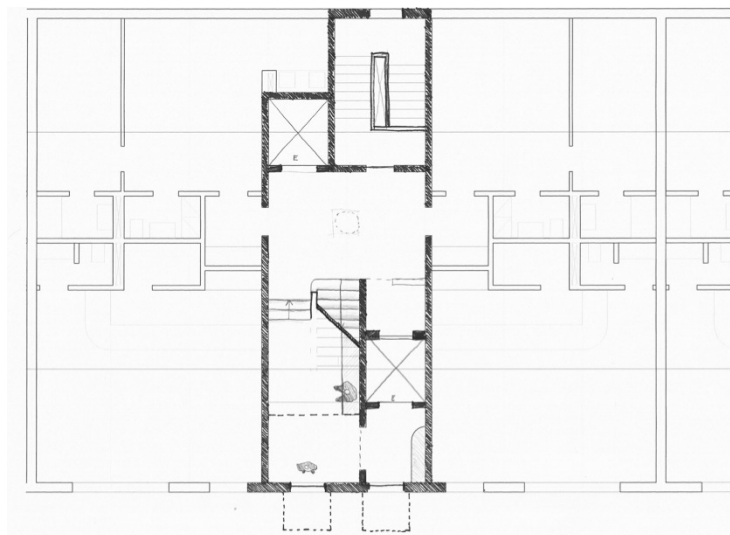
Planta Átrio Tipo – Desenho do autor.
